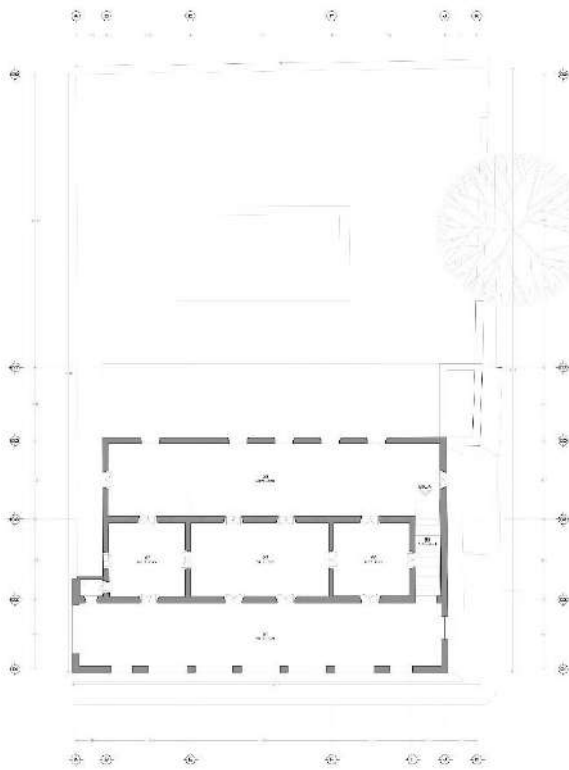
Planta arquitectónica baja hipotética posterior a la primera remodelación en la primera mitad del siglo XX del edificio de Xculucya. Fuente: Elaboración propia.
